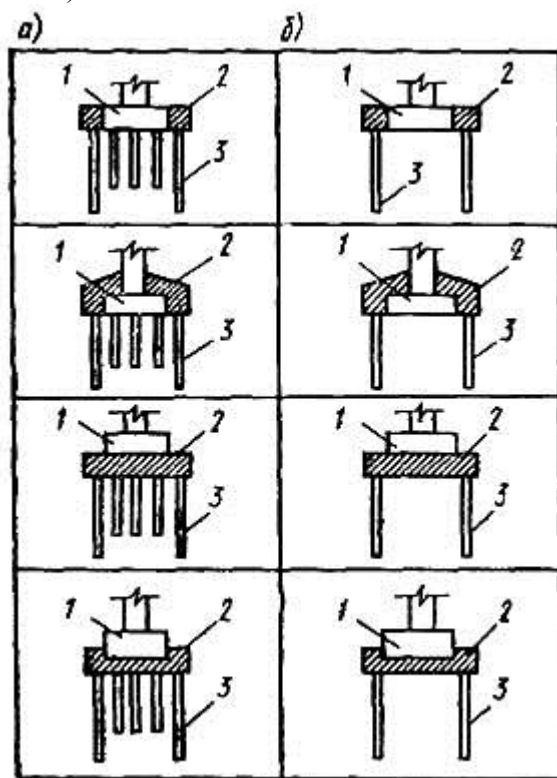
Схемы усиления фундаментов на свайном (а) и естественном (б) основаниях: 1 – усиливаемый фундамент; 2 – ростверк усиления; 3 – сваи усиления
